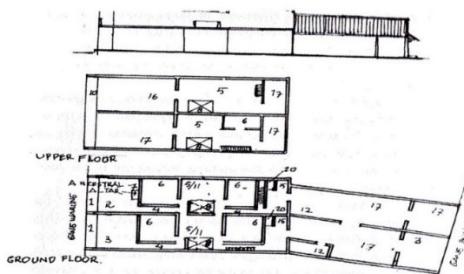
a) The type of Shop house with short footprint (2 floors)
